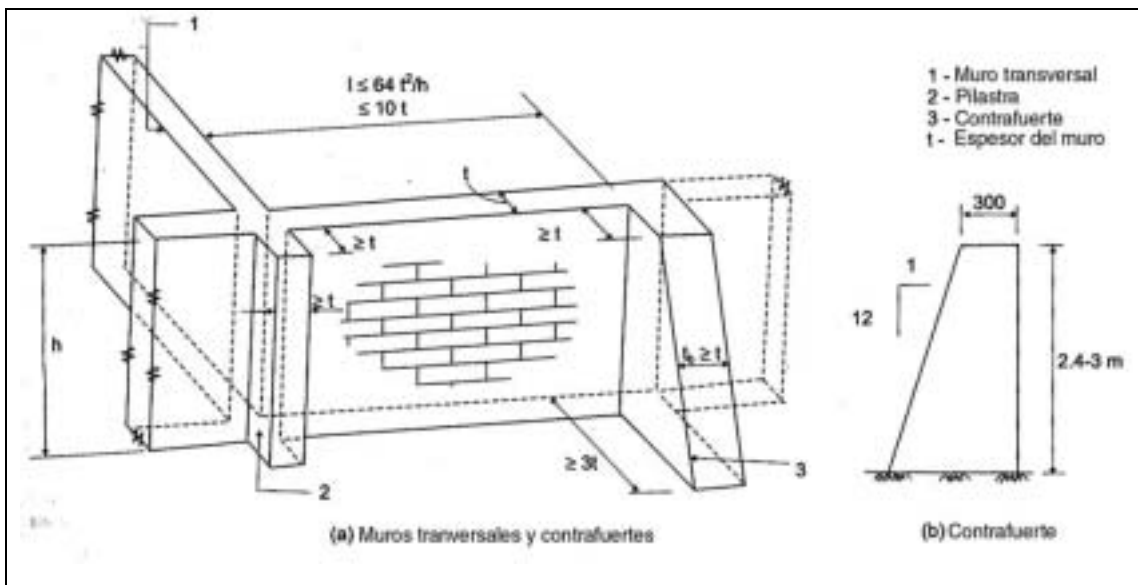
Edificación de adobe con Contrafuertes y Pilastras en El Salvador (Equipo Maiz, 2001, Dowling 2002)
